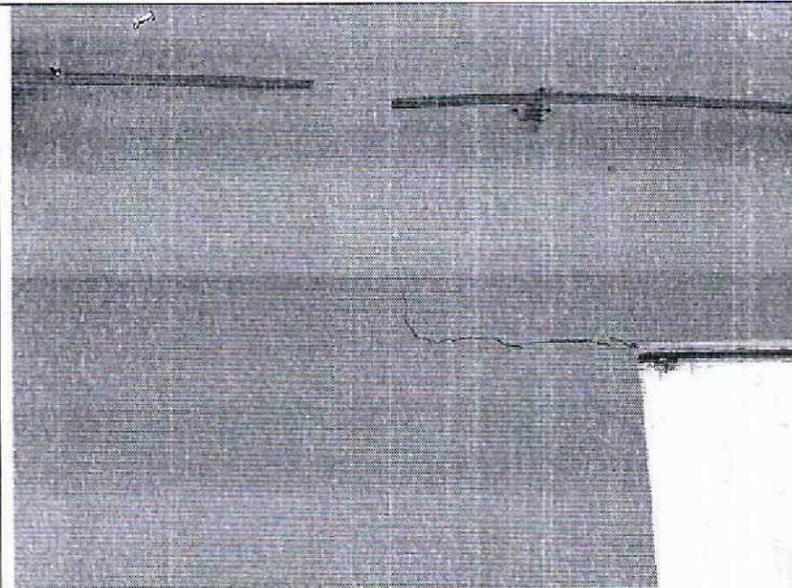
Grietas en parte alta del muro extremo occidental.
